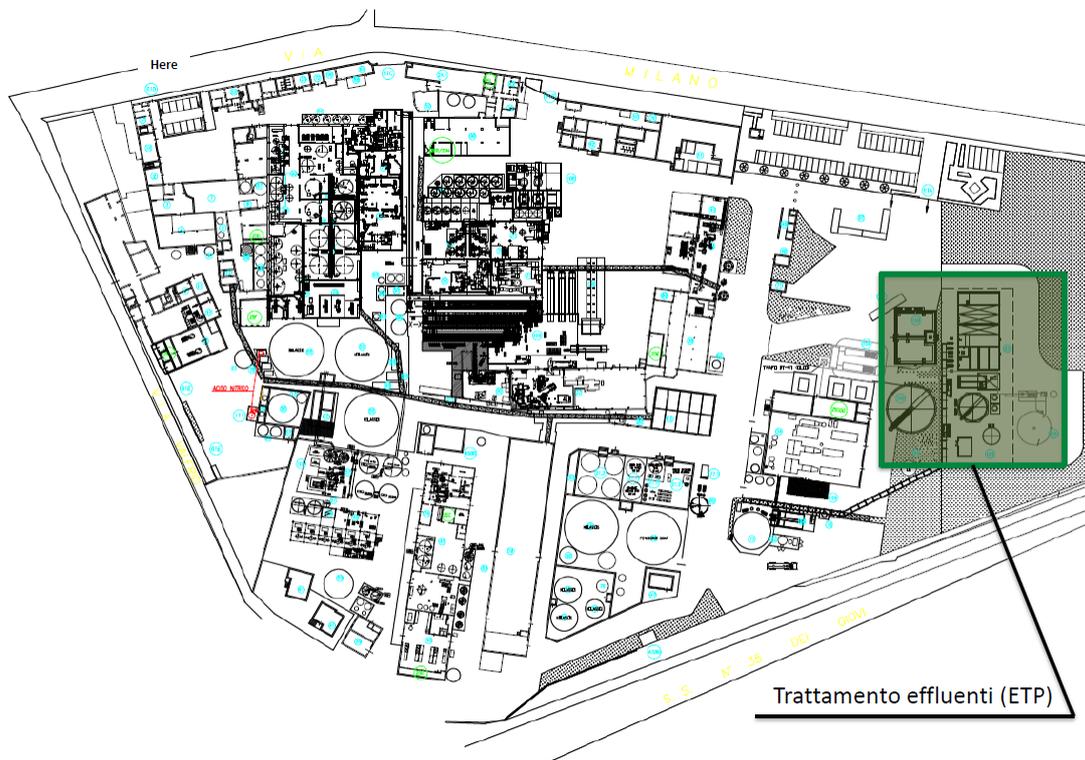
Planimetria - Depurazione acque e trattamento effluenti
